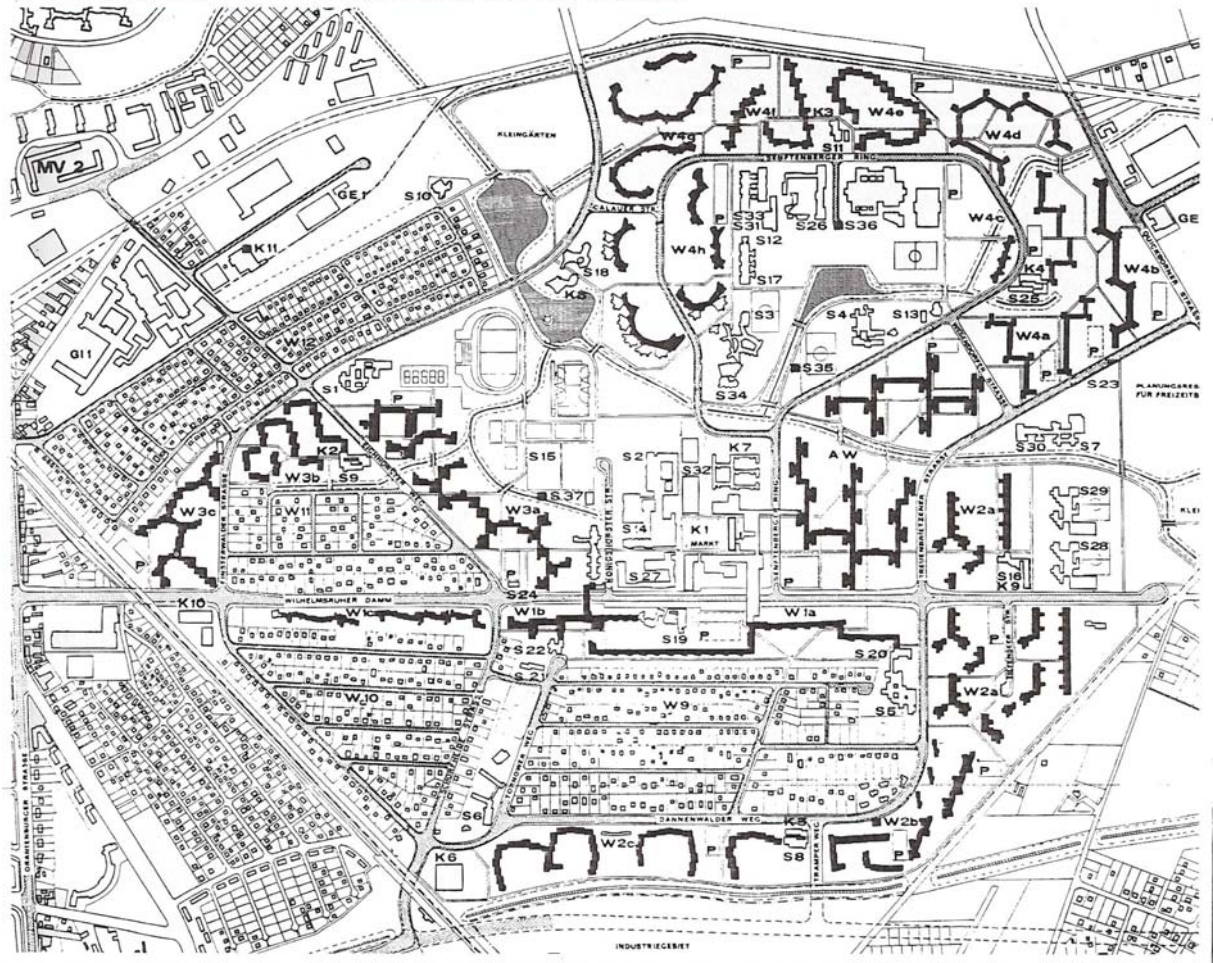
il Märkisches Viertel, planimetria del 1970 (1).
